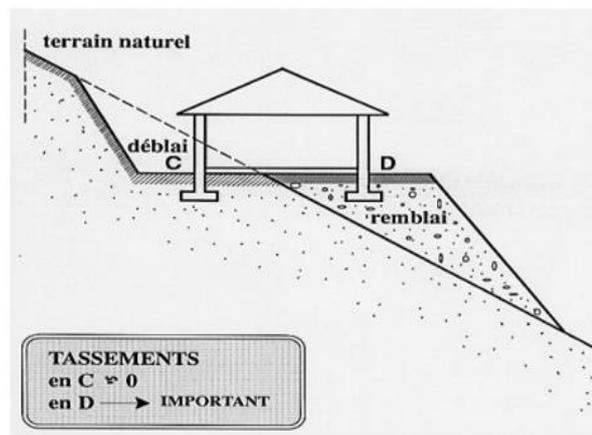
Tassement différentiel des fondations-Création d'une plate-forme sur terrain en pente.
